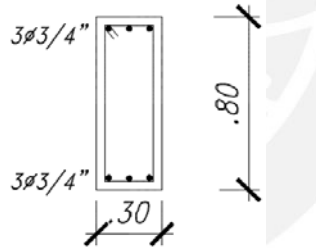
Sección de viga S1 ($M_n=33$ tnxm)
